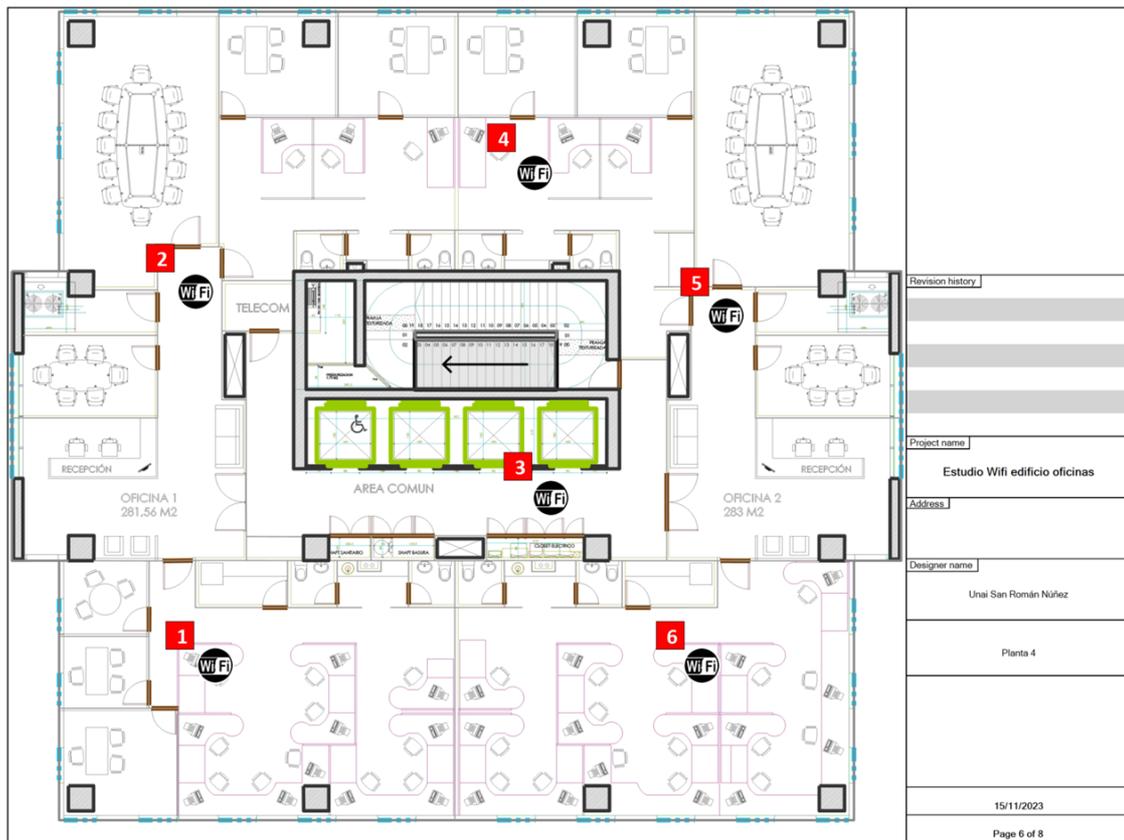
Posicionamiento Puntos de Acceso. Planta 4.
